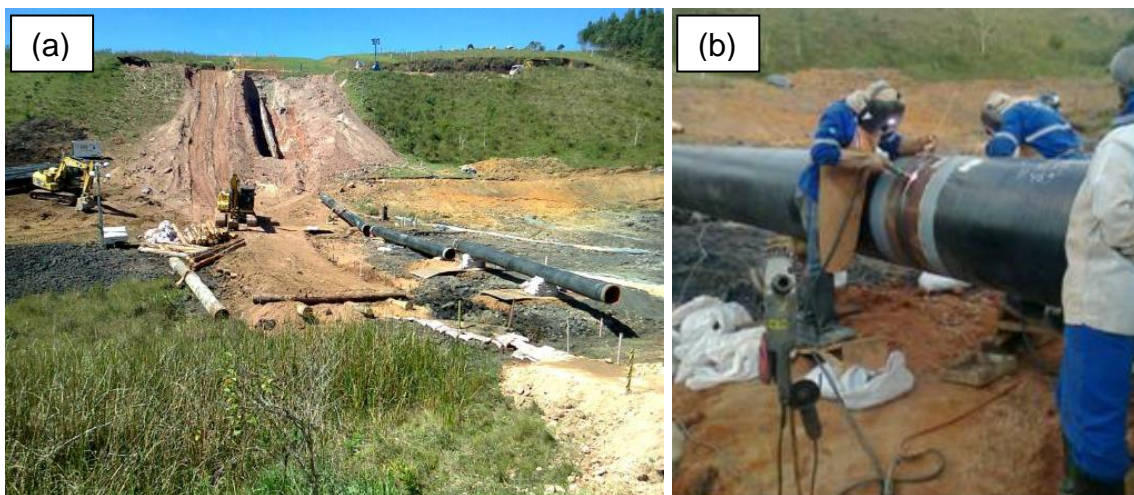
(a) Desfile de dutos para posterior execução de soldagem. (b) Soldagem de dutos [5].
